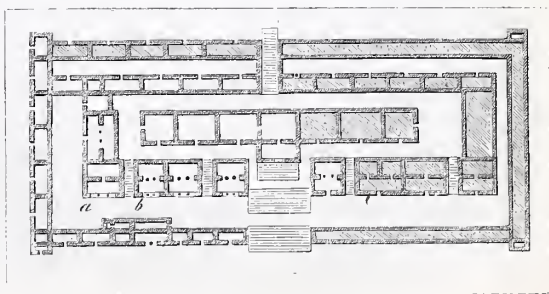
Palast zu Yaxi (Grundriss).
